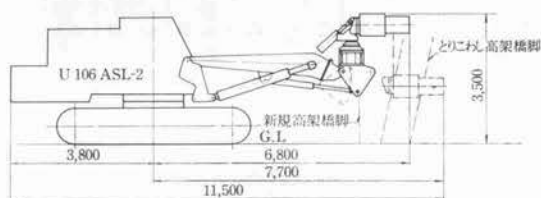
コンクリート無騒音破壊機短尺ブーム取付図
